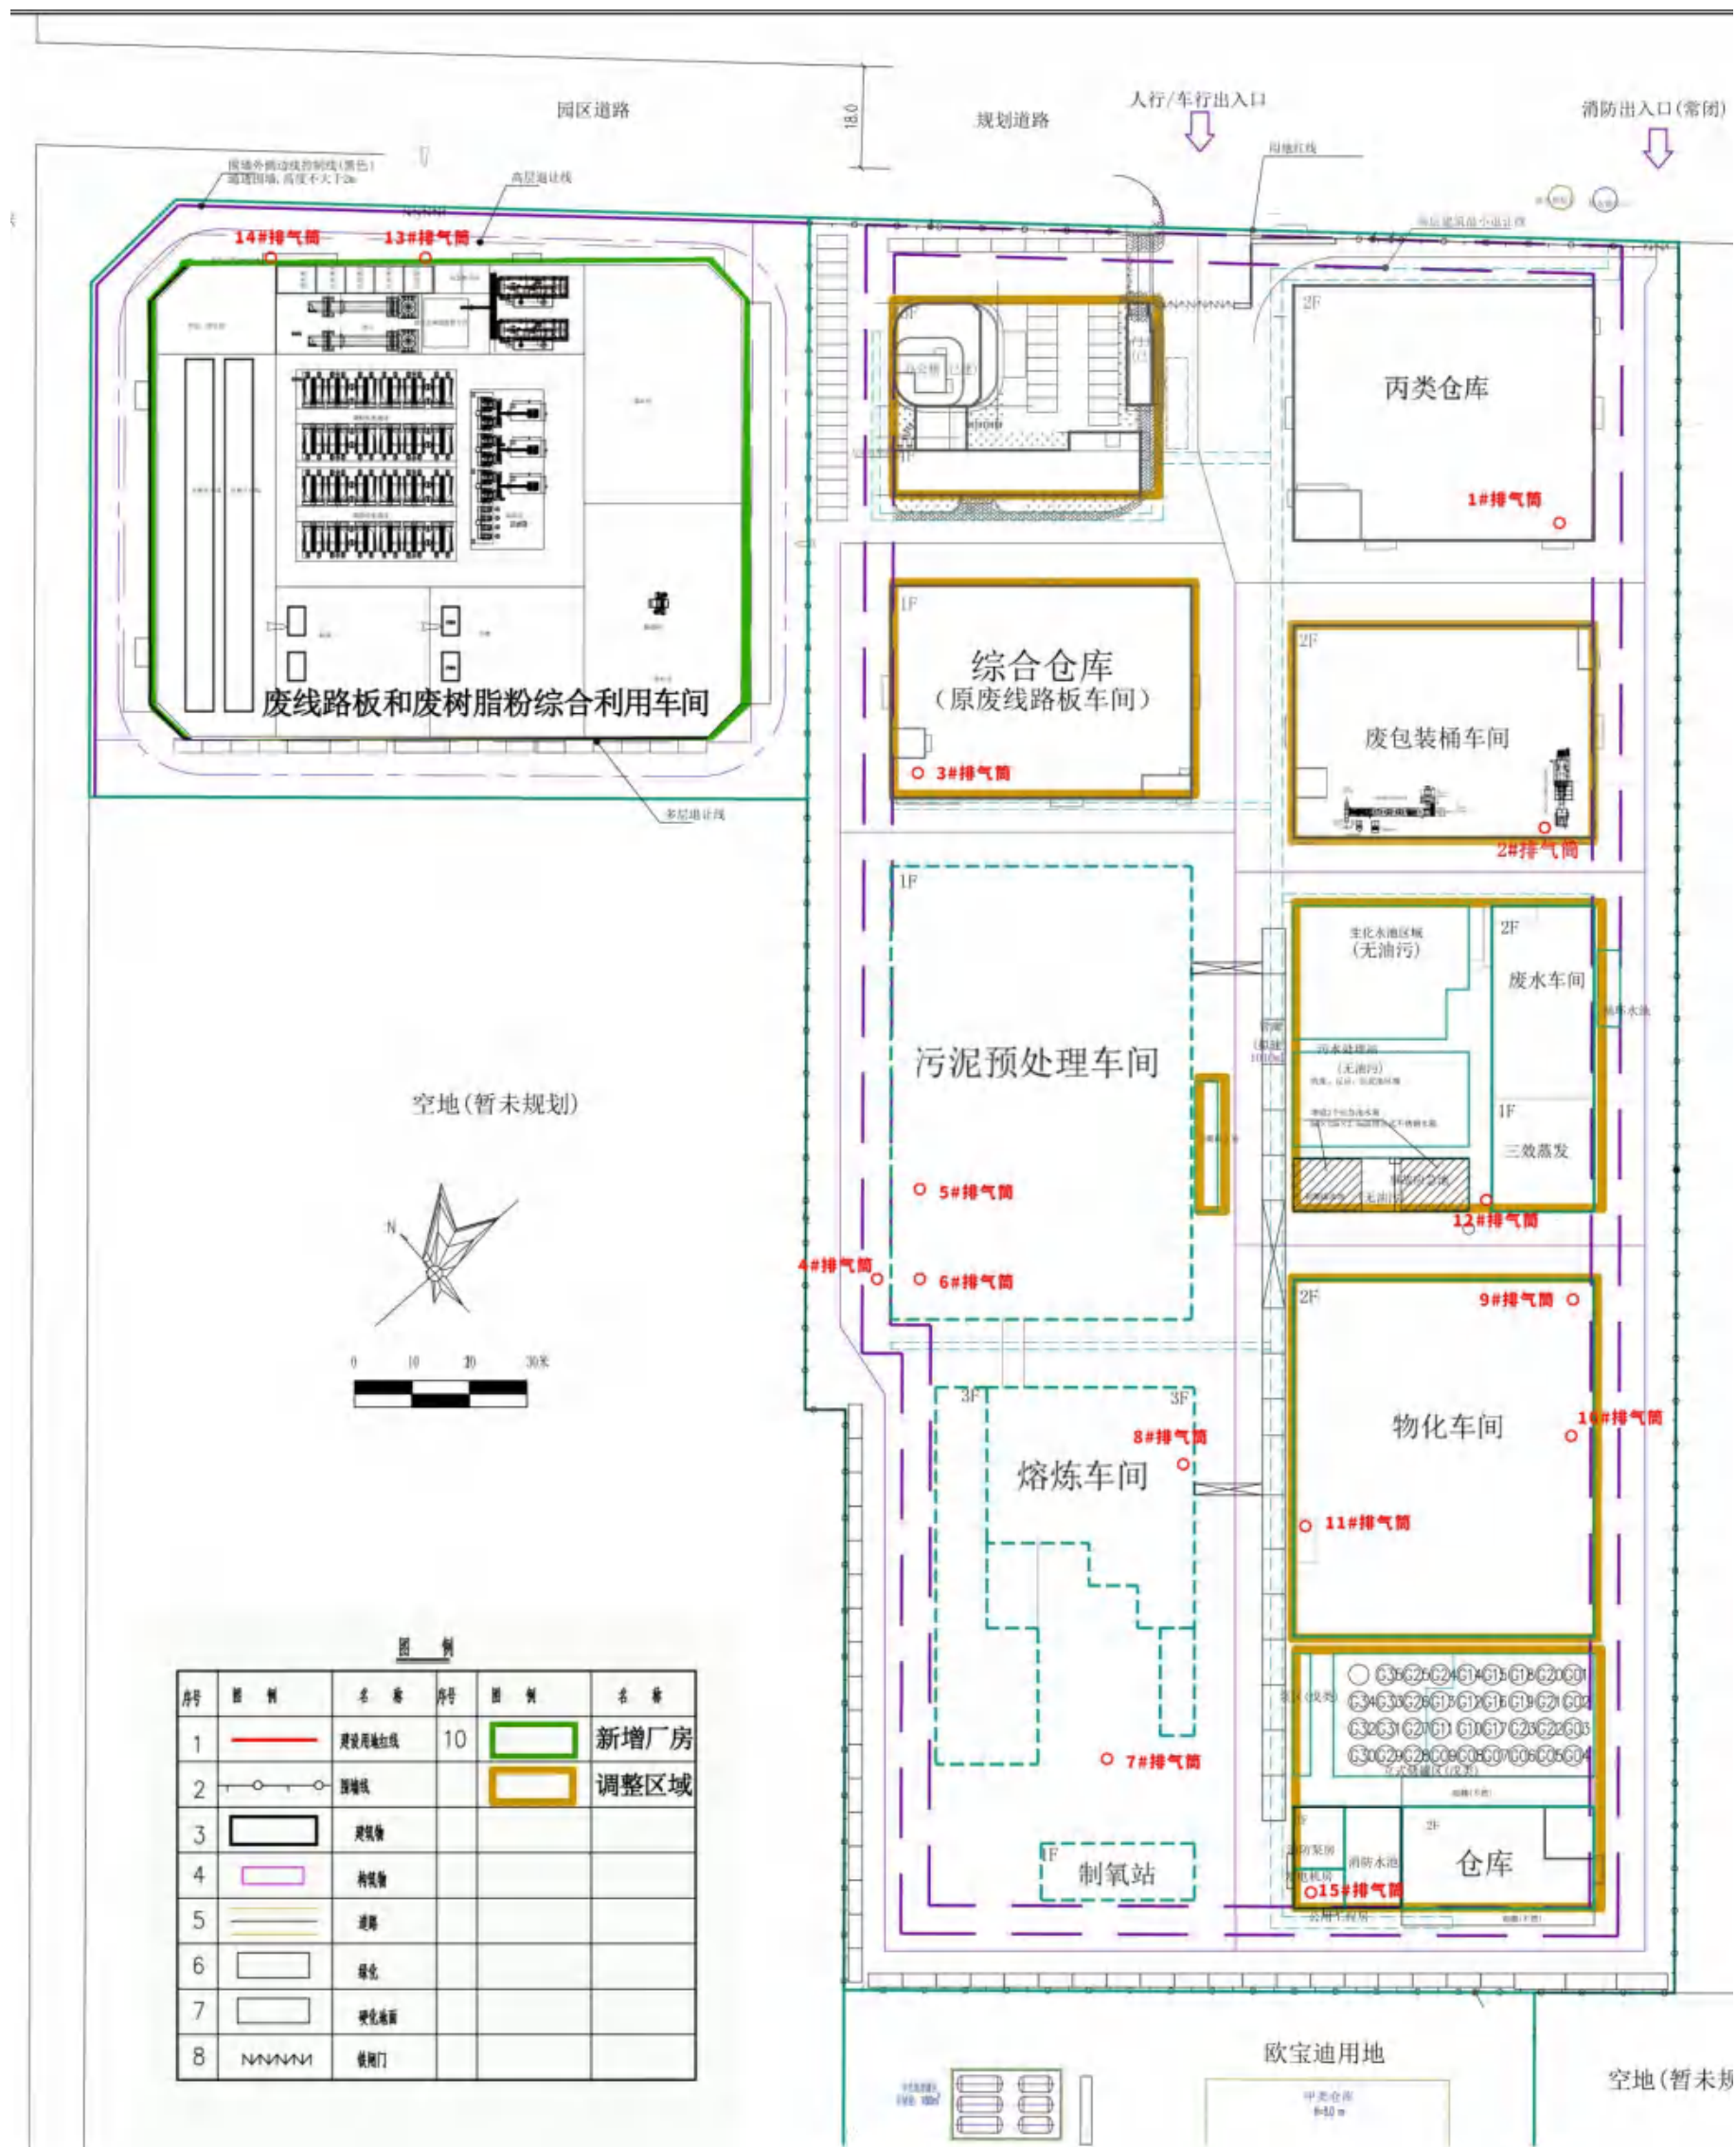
原技改扩建项目实施后全厂总平面布置图
